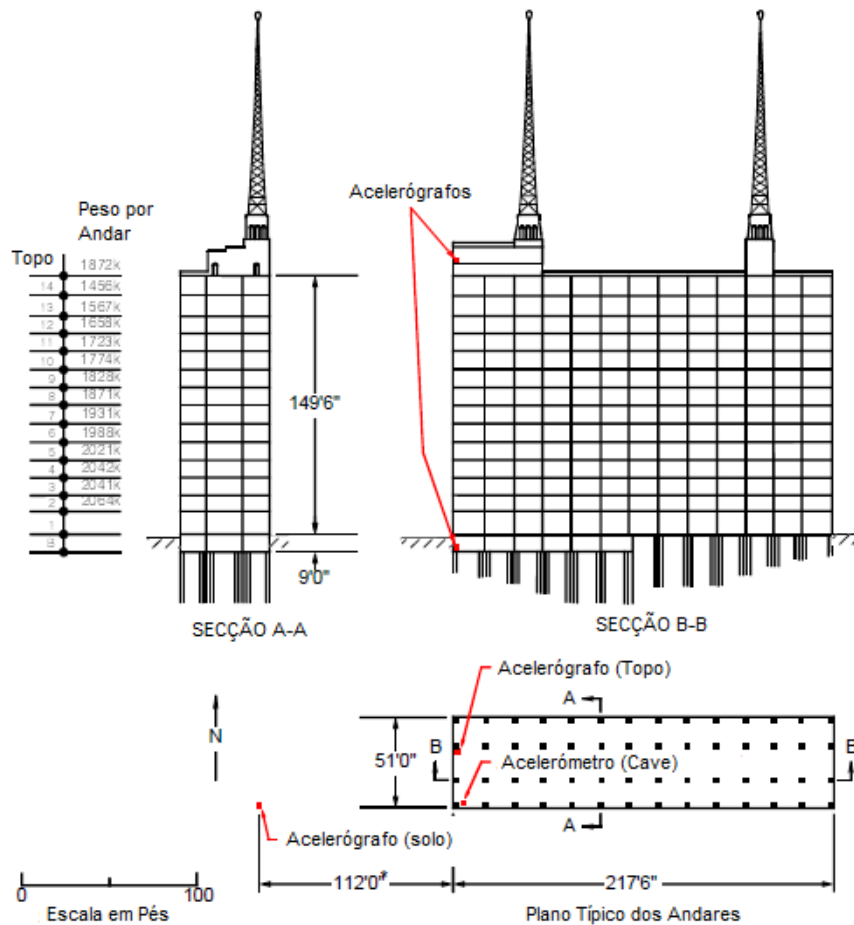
Esquema dos Alçados e Planta do “Hollywood Storage Building” em meados de 1950. Localização dos acelerómetros no topo e na cave do edifício e um terceiro colocado a 28 metros a oeste do edifício. Adaptado de [98].
